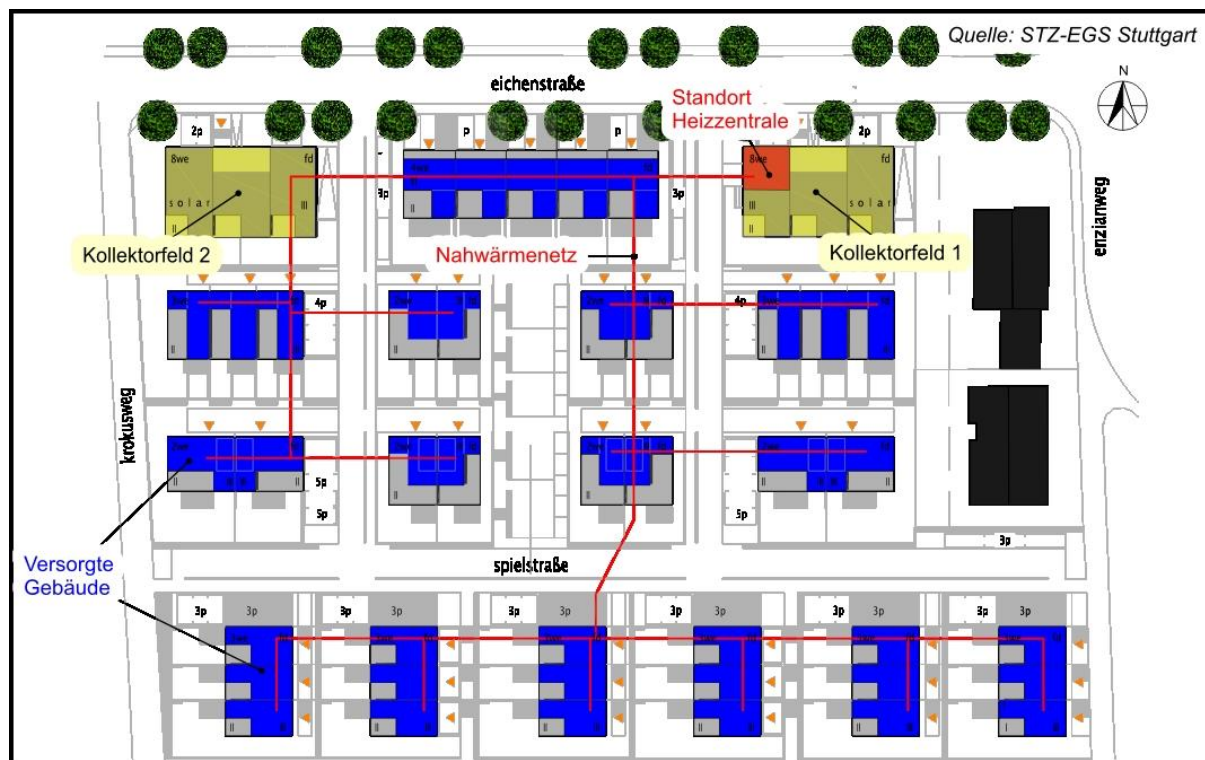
Lageplan Weinstadt-Endersbach, Wohngebiet Eichenstraße
